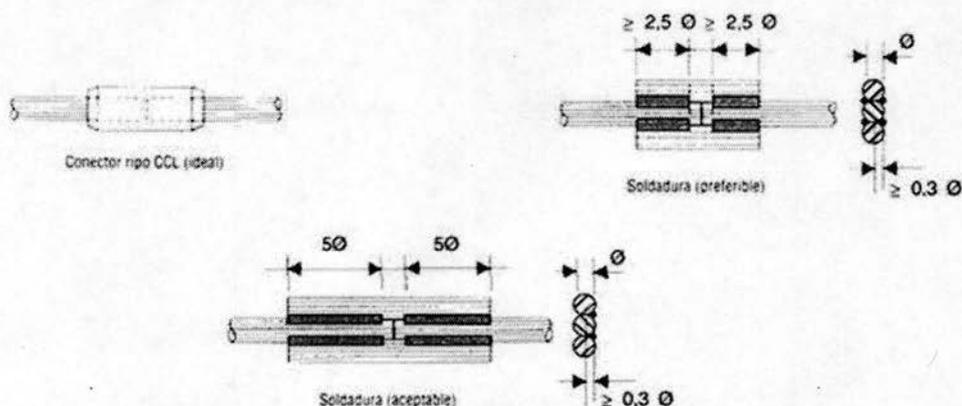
Conector mecánico (manguito) o soldadura
